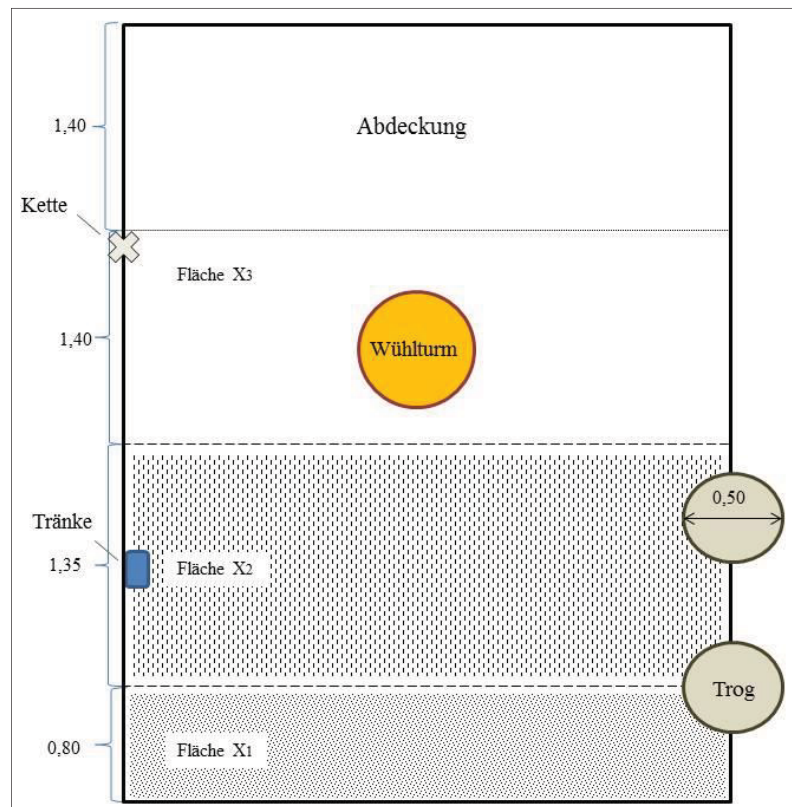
Zweiflächenbucht Aufzucht (Liegebereich X3 Beton planbefestigt; Kotbereich Betonspalten X2 und Kotbereich Gussroste X1)
